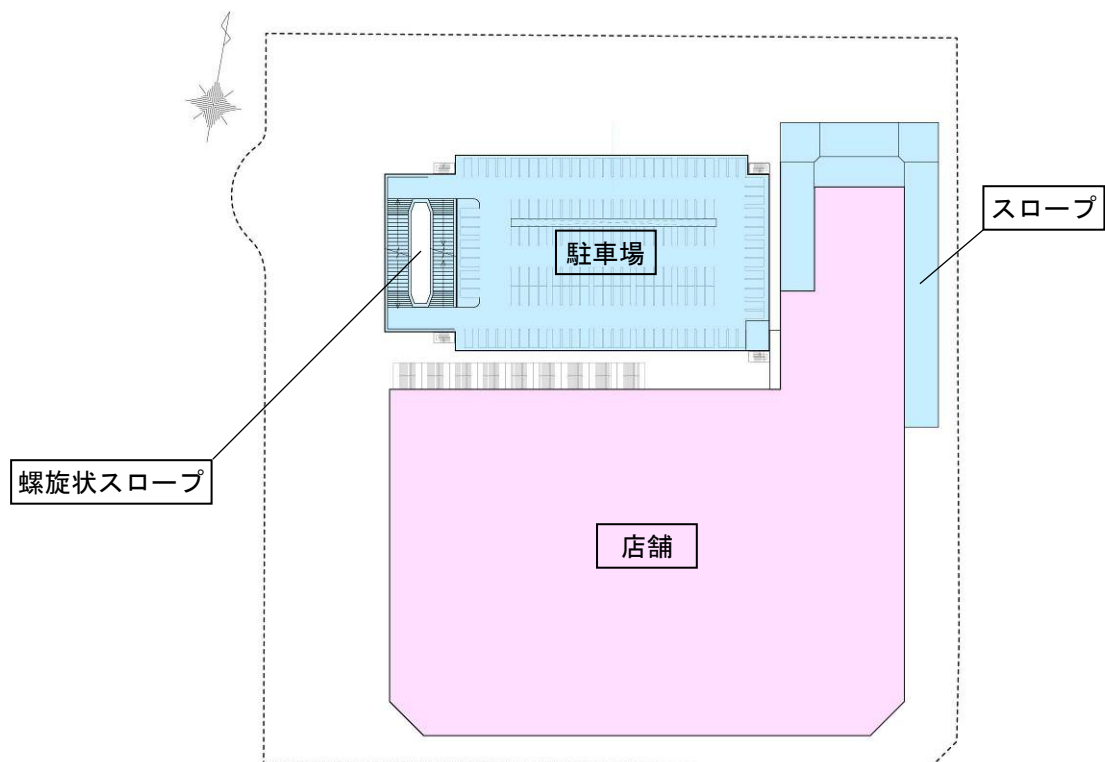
(3) 各階平面図(商業棟 3 階, 駐車場棟 5~6 階) 【評価書時】
